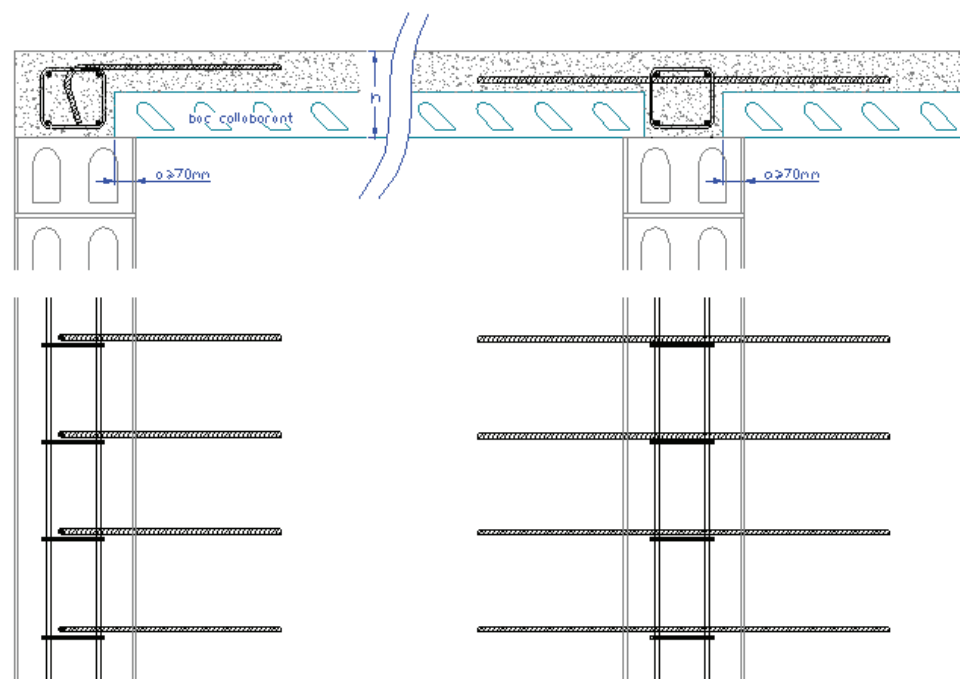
Connexion de la dalle avec appuis en maçonnerie
